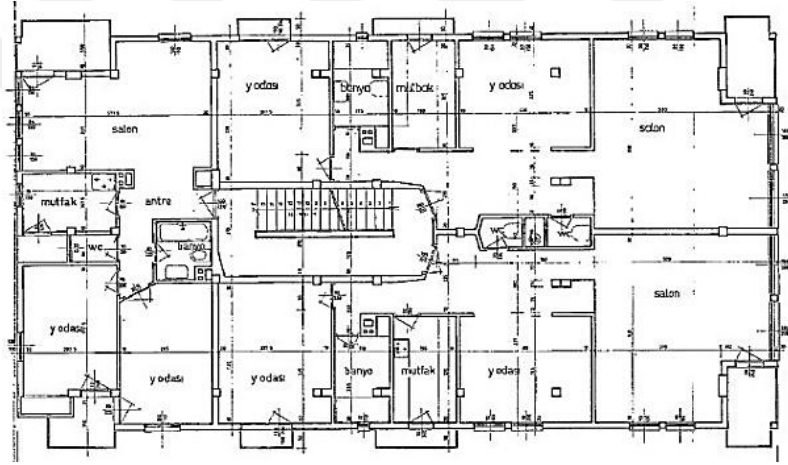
Gül Apartmanı, Normal Kat Planı.²⁵¹
